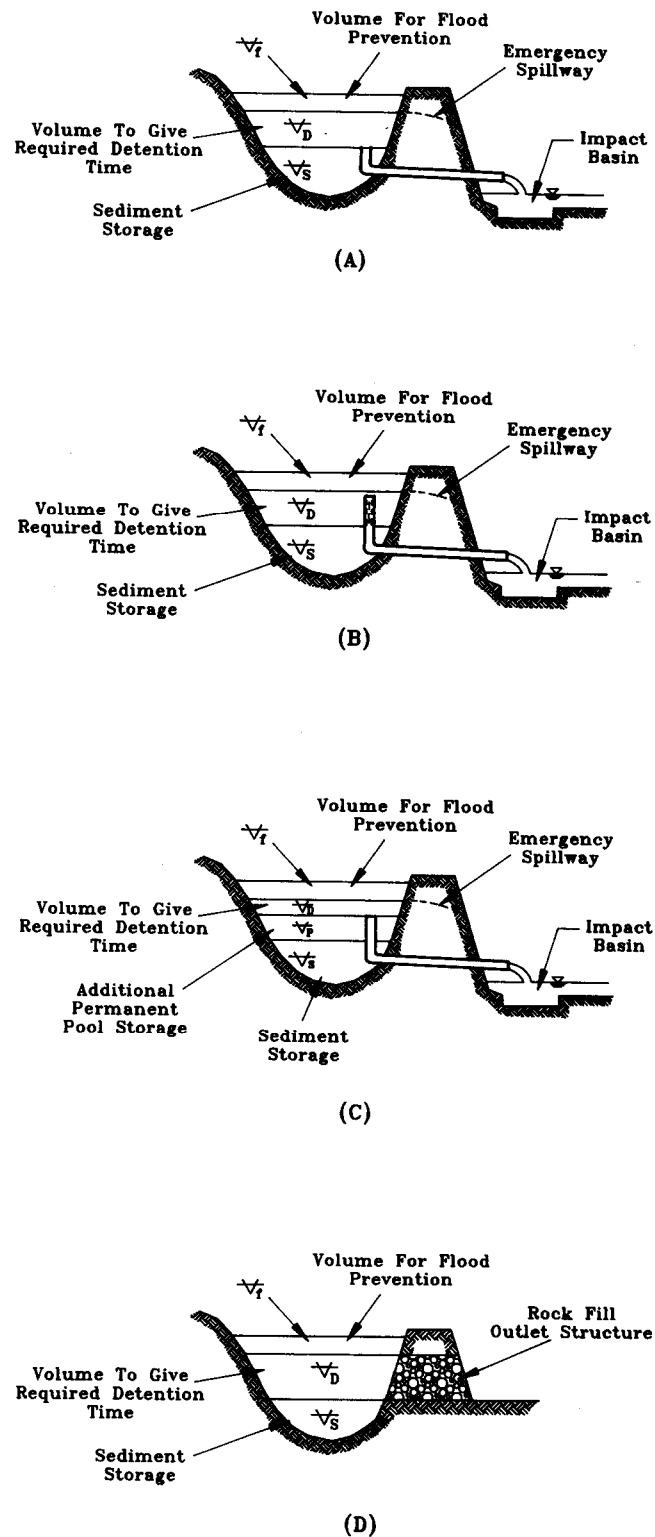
Pré-tratamento. Observar as quatro maneiras básicas que temos de saída, desde parede porosa de pedras até em D até as saídas em A,B,C.
